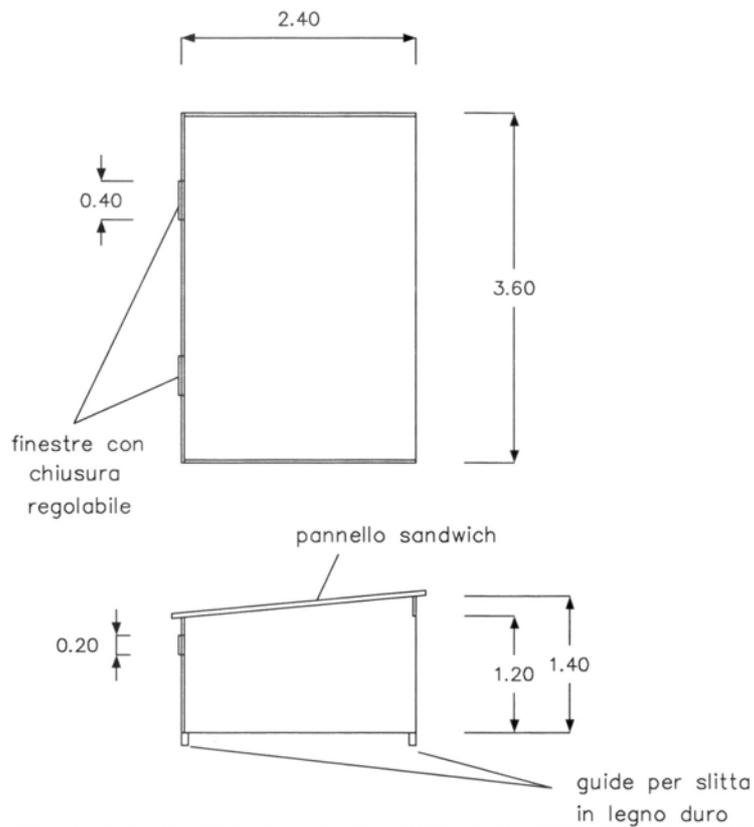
Pianta e sezione di capannina per le fasi di fecondazione-gestazione e ingrasso
